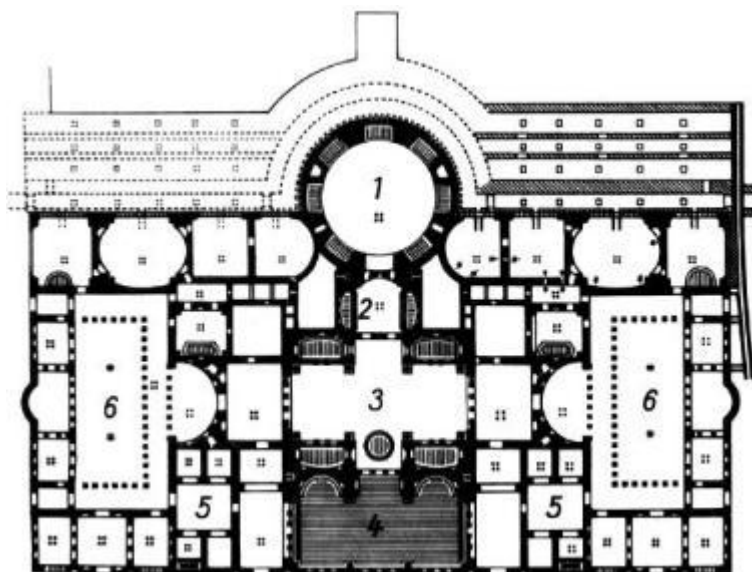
Grundriss der Caracalla-Thermen in Rom.²⁸
